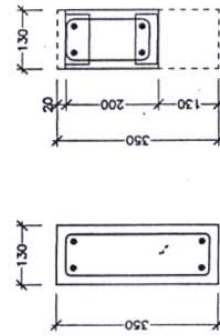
แสดงแบบ Part Drawing ของคานต่อเนื่องทั่วไป ชนิดที่มีแผ่นต่อเสาด้านบน
